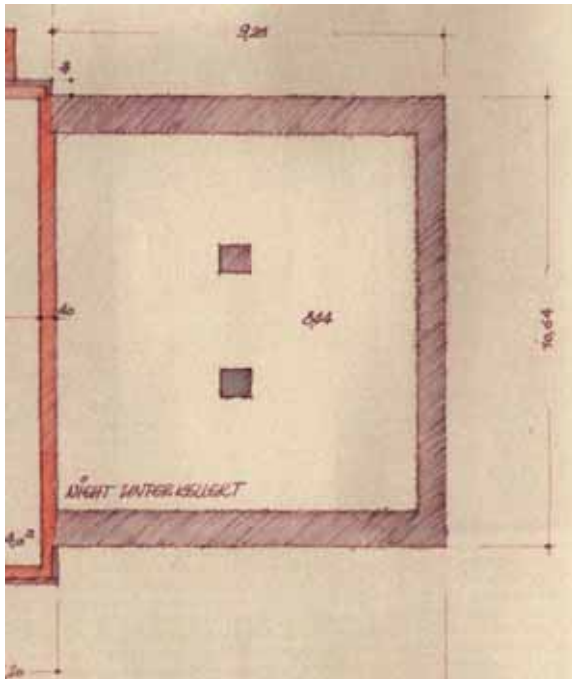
Allerheiligenkapelle, Grundriss (Ausschnitt: Realgymnasium am Egidienberg, Untergeschoss, 1955; Bauregistratur Nürnberg, Akte Innerer Laufer Platz 11).
